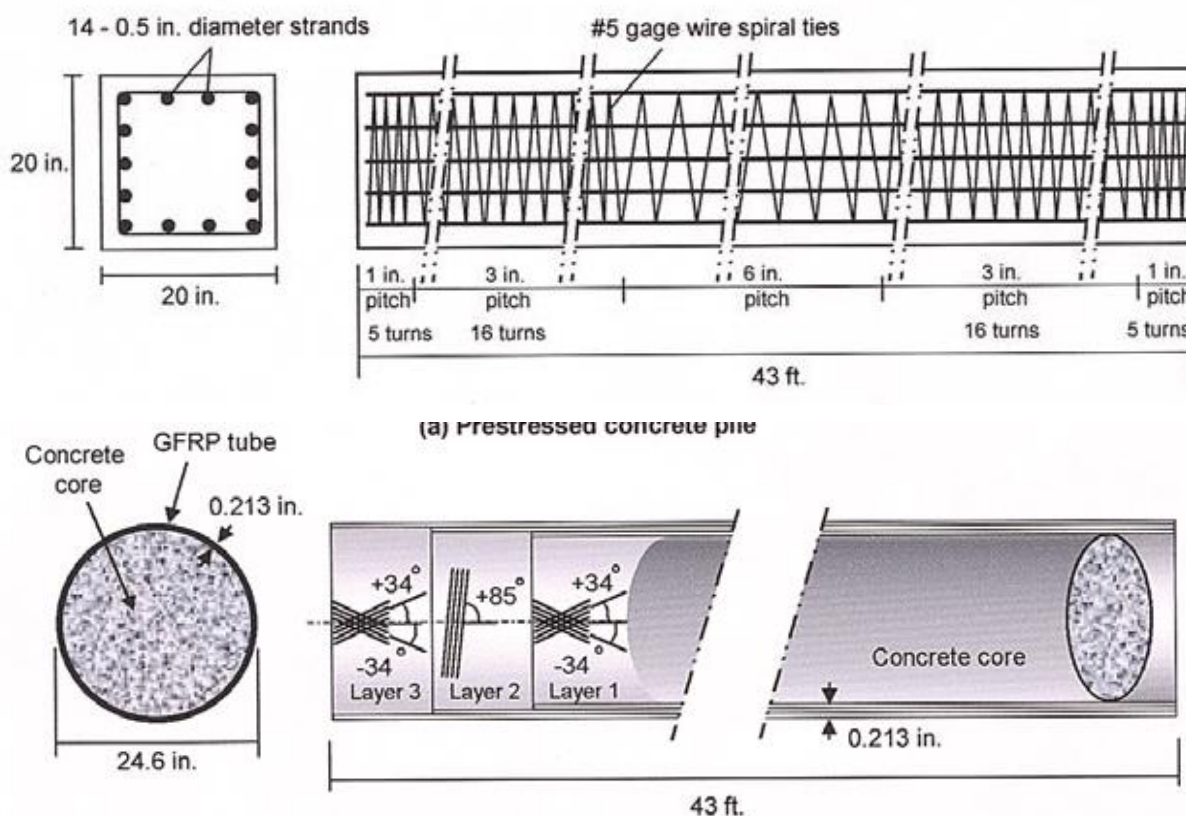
Геометрия и армирование свай: а) преднапряженной железобетонной; б) трубобетонной с фибропластиковой оболочкой [10]
